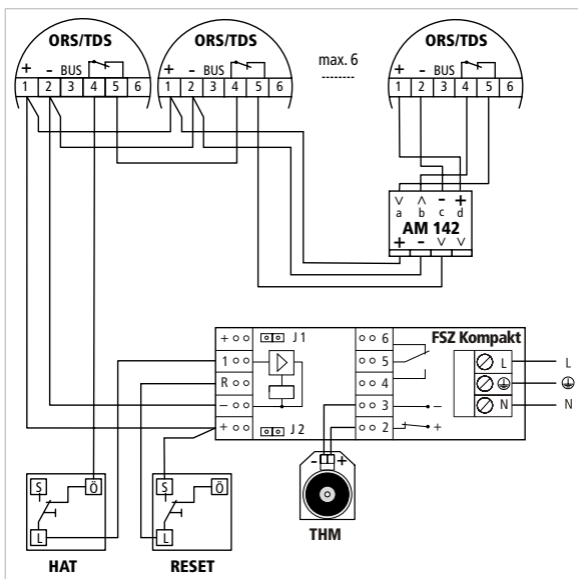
Anschluss mit Feststellvorrichtung, Handauslösetaster, Resettaster und externen Brandmeldern
